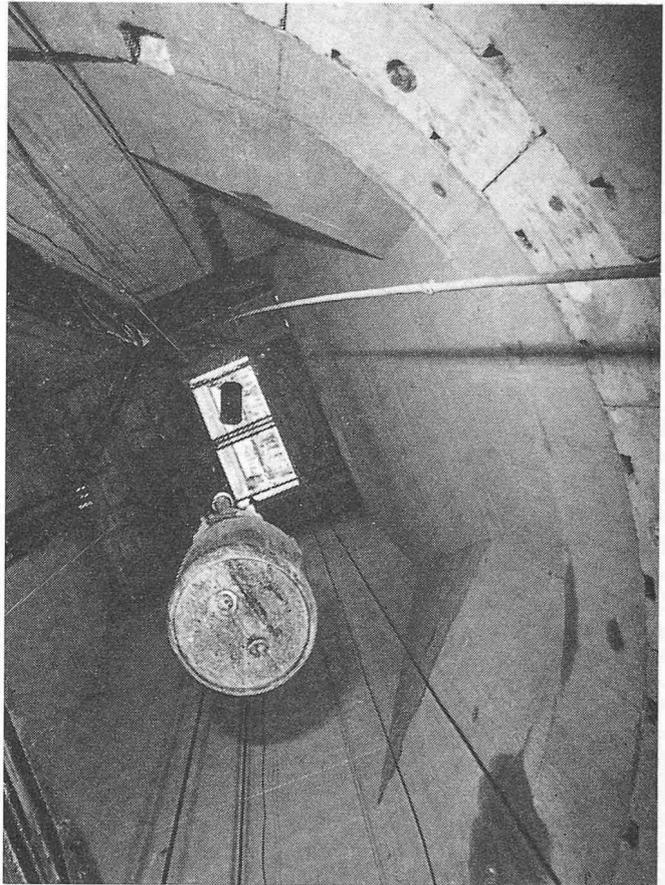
Lüftungsschacht Hospental, obere Schachtmündung mit Übergang vom kreisrunden Profil mit Fertigelementauskleidung auf das Rechteckprofil
